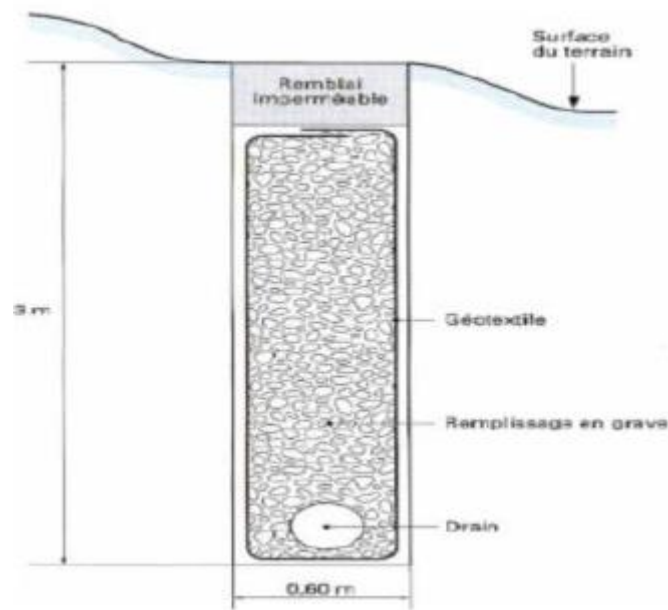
Coupe type d'une tranchée drainante (DURVILLE & GILLE, 2008).
